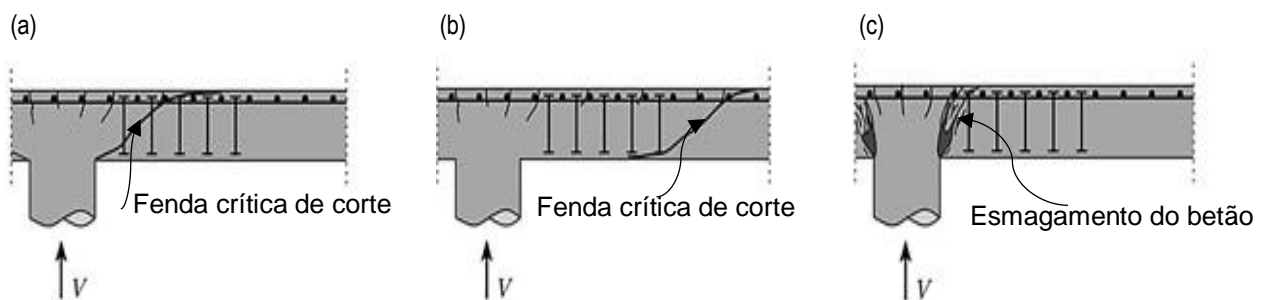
Zonas de rotura por punção: (a) Dentro da zona reforçada com armadura; (b) Fora da zona reforçada com armadura; (c) Esmagamento do betão (adaptado de [18])
